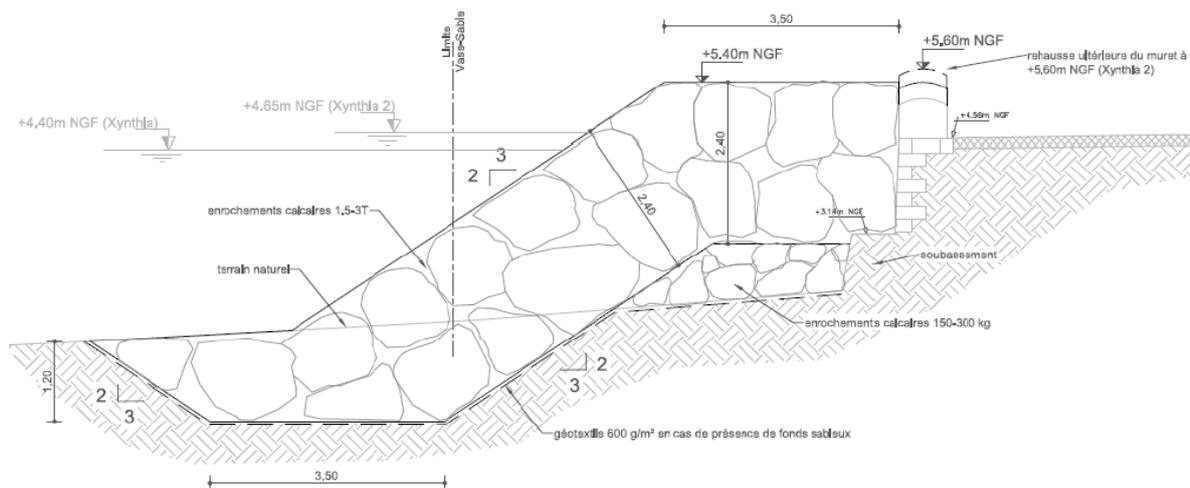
vue en coupe de la protection le long de l'avenue de l'Ile Madame
